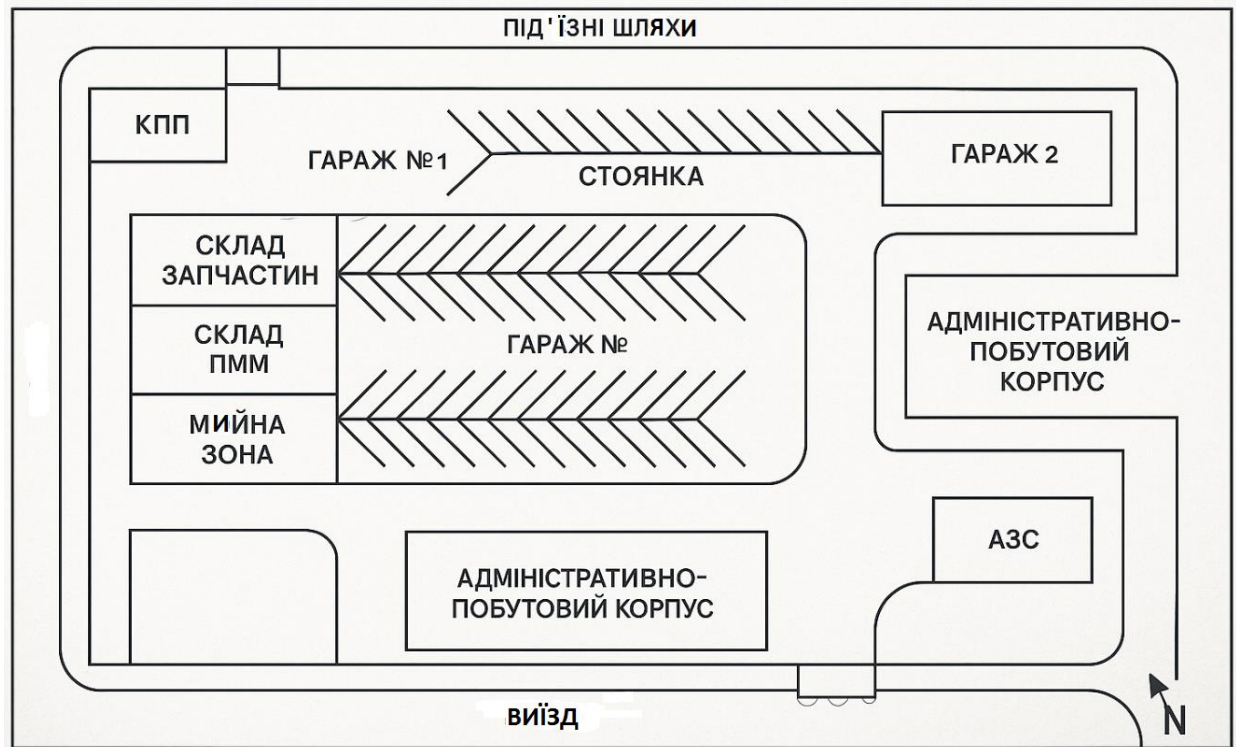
Генеральний план АТП на 90 вантажівок
